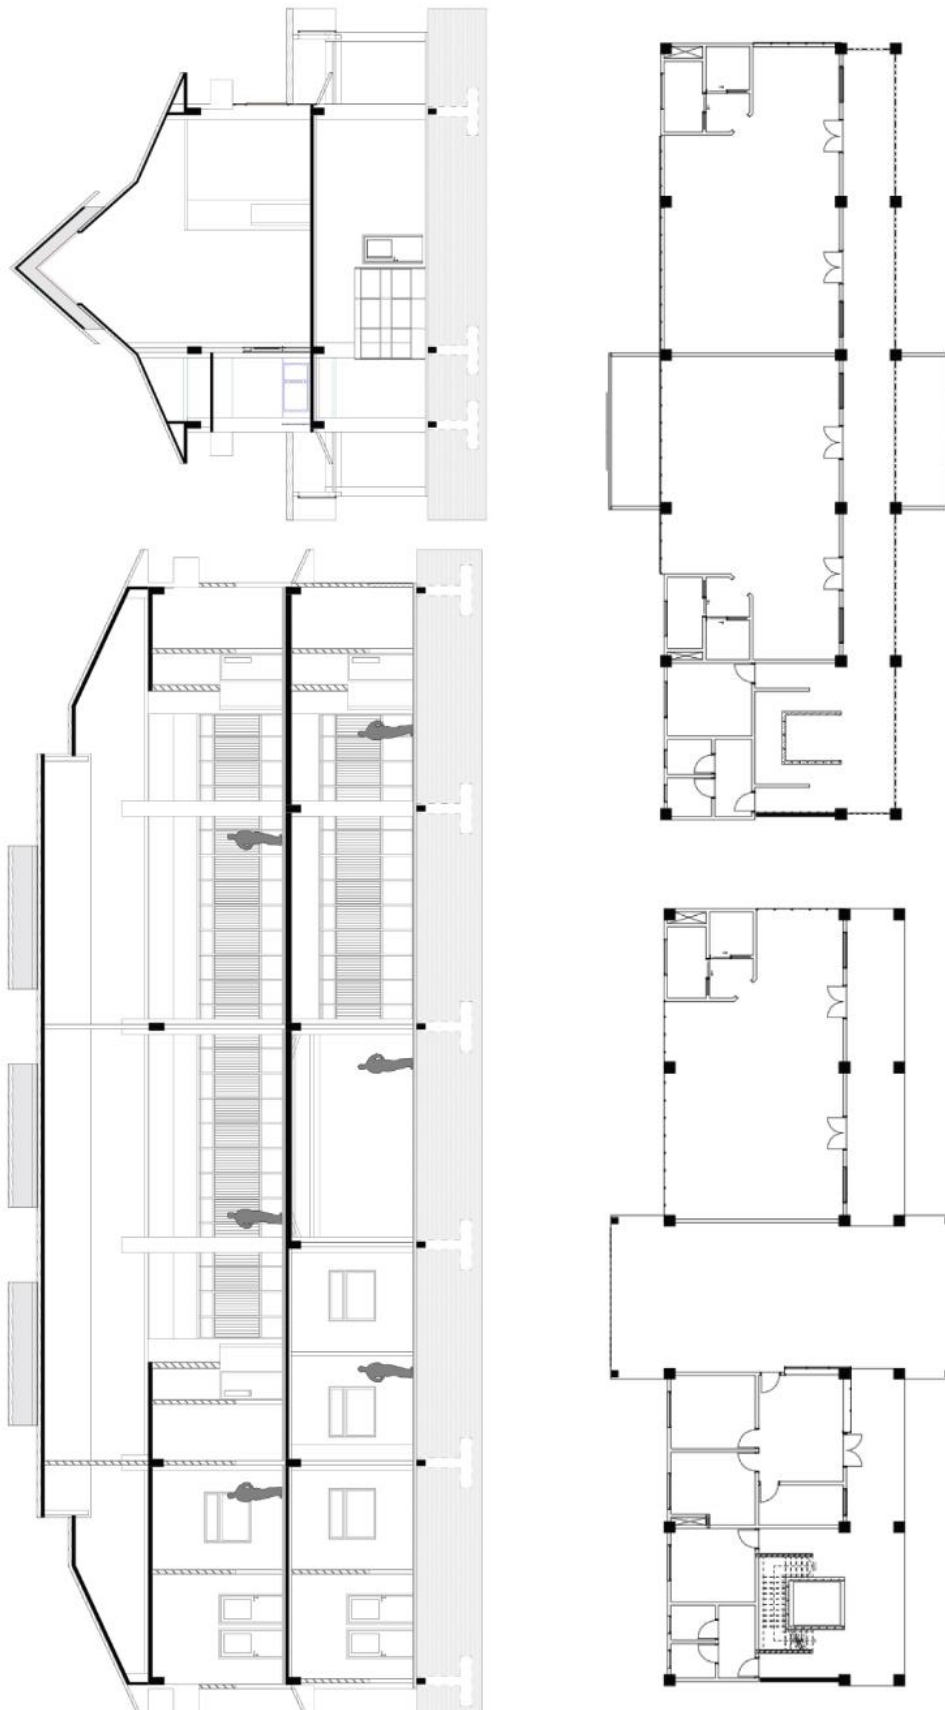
13 Konsep Bangunan Gedung Serbaguna
